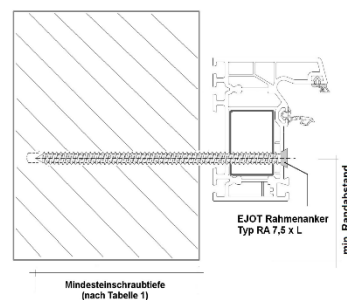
Montageausführung: seitlicher Anschluss für Kunststofffenster mit Stahlarmierung (2 Wandung) in hochwärmegedämmten Mauerwerk
